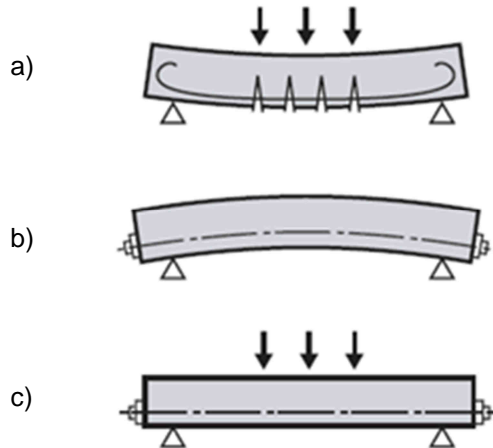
Viga simplesmente apoiada. (Corven e Moreton 2004).
